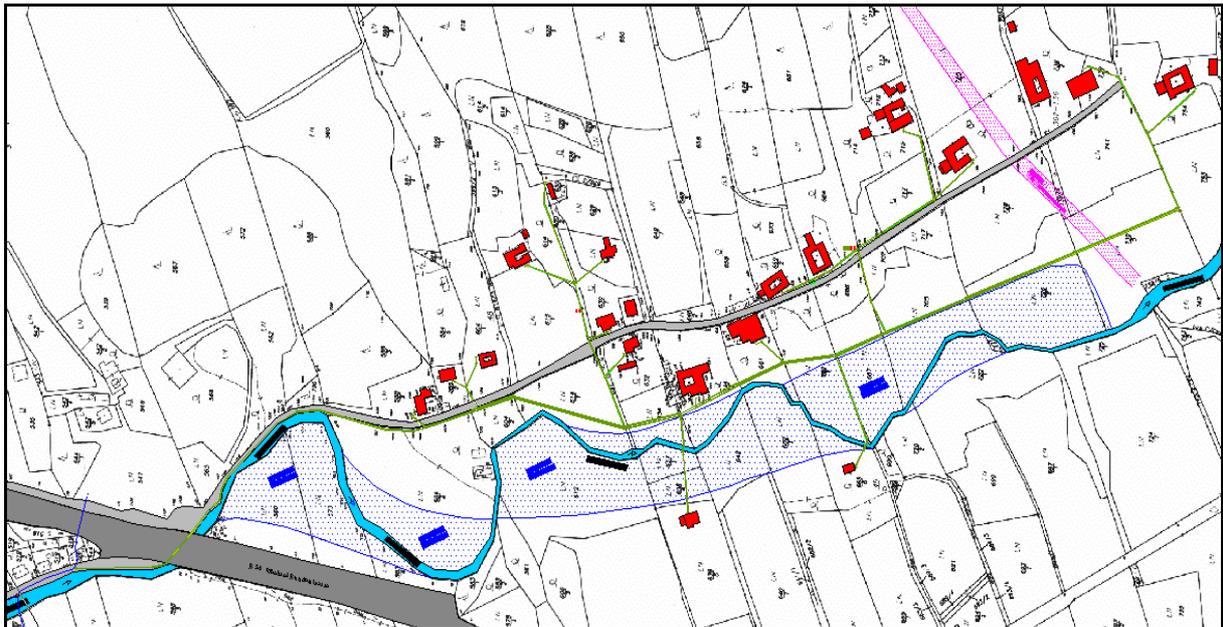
LAGEPLAN Variante 3 – Ableitung nach Grafendorf
